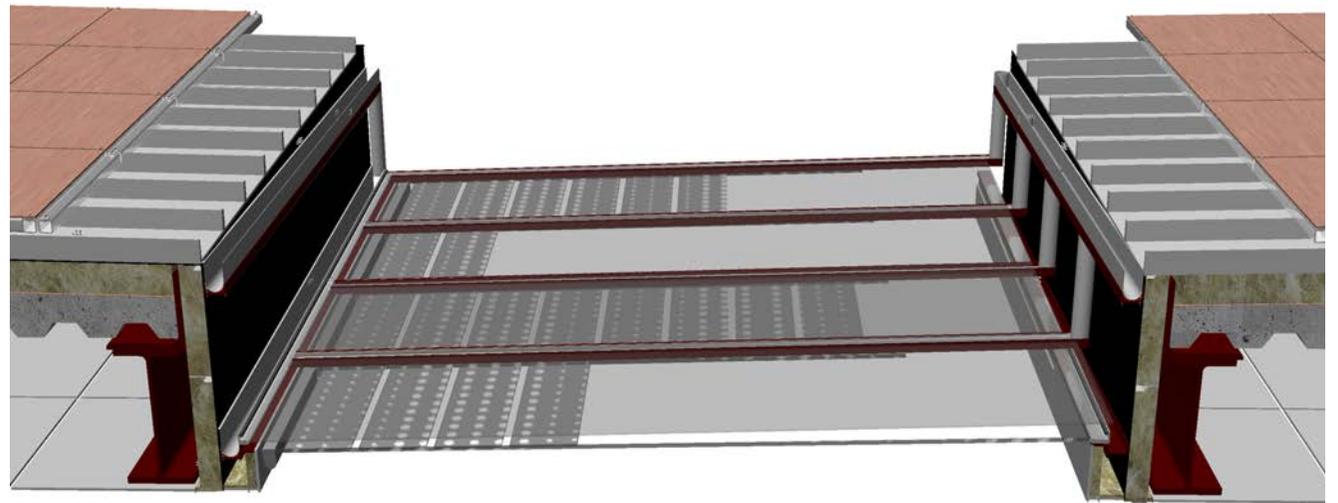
Detaillierte 3D-Darstellung des Entwässerungssystems
